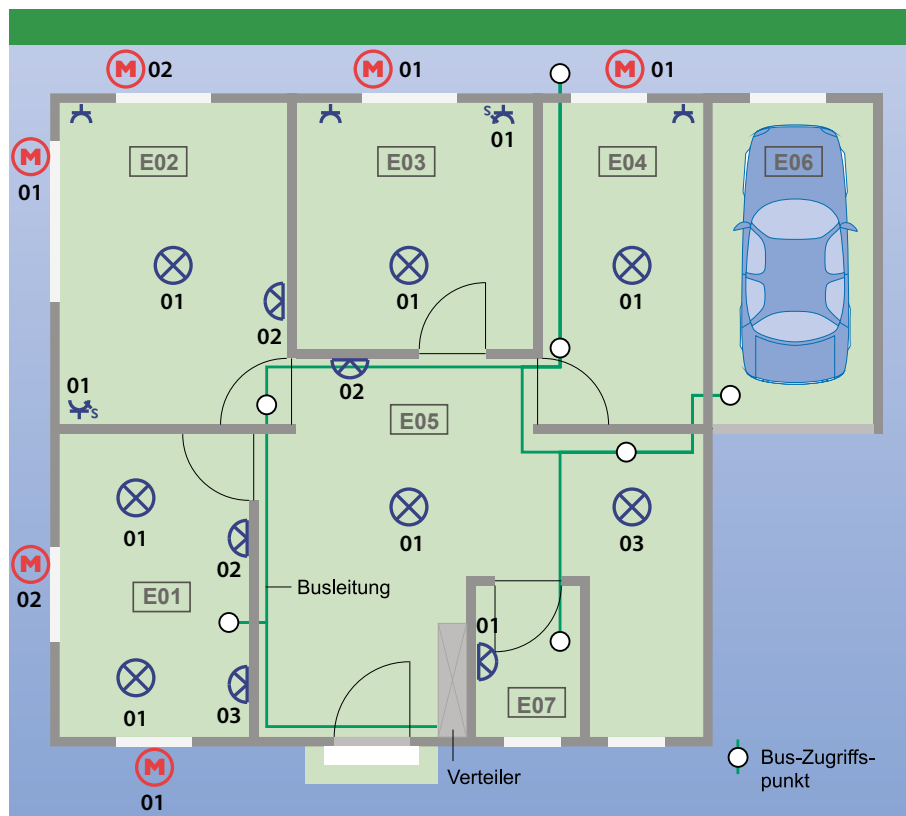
Grundriss mit fortlaufender Nummer pro Gewerk (Quelle: KNX Swiss)
